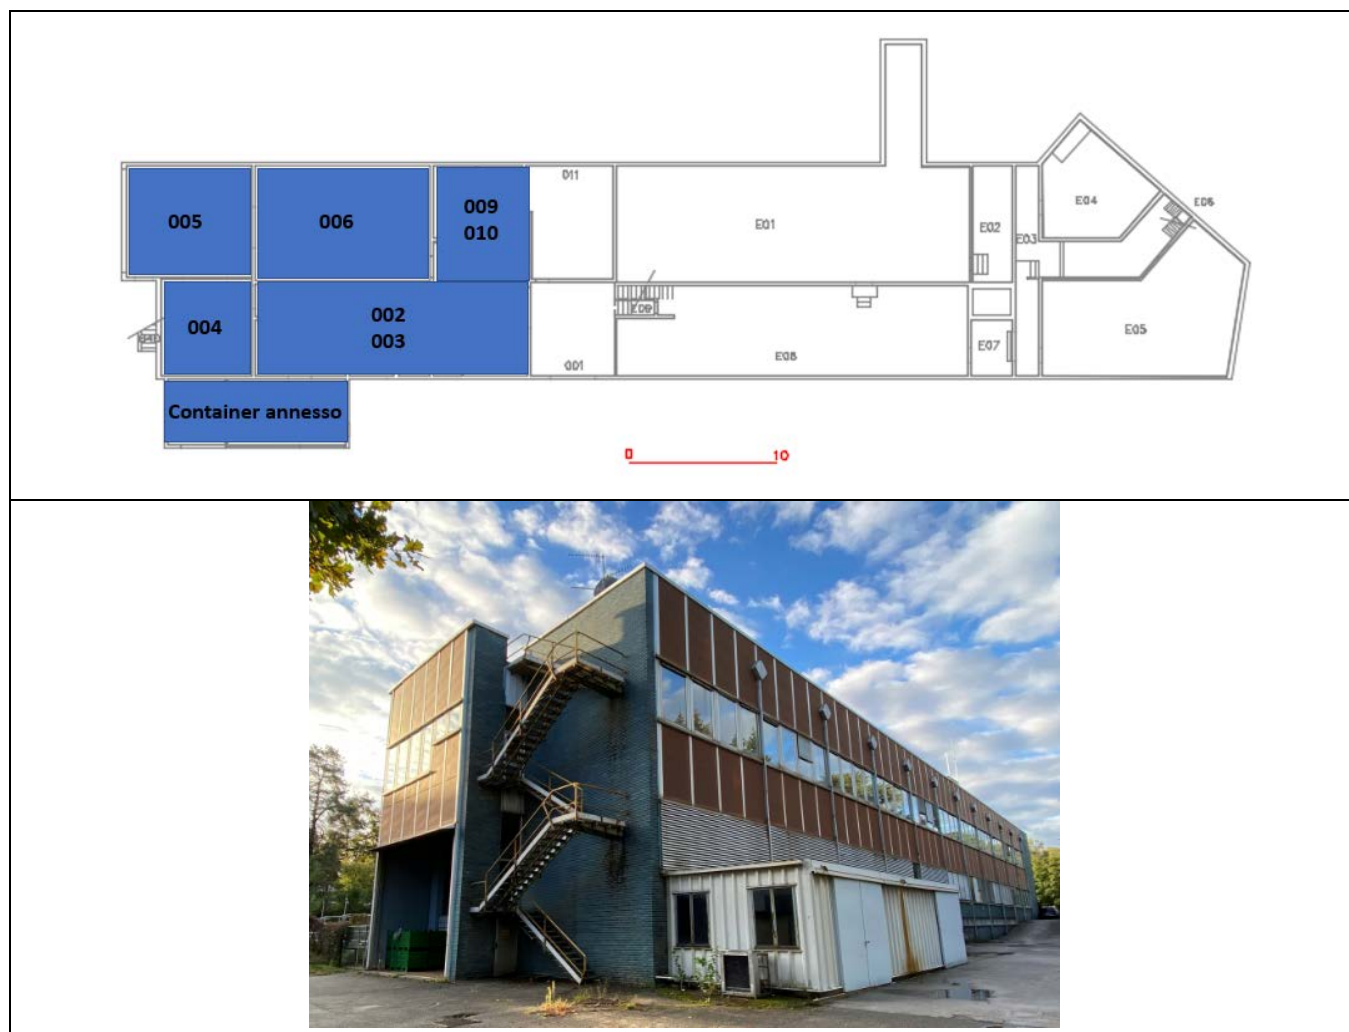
Edificio 21n (Parte d’interesse) – Pianta
